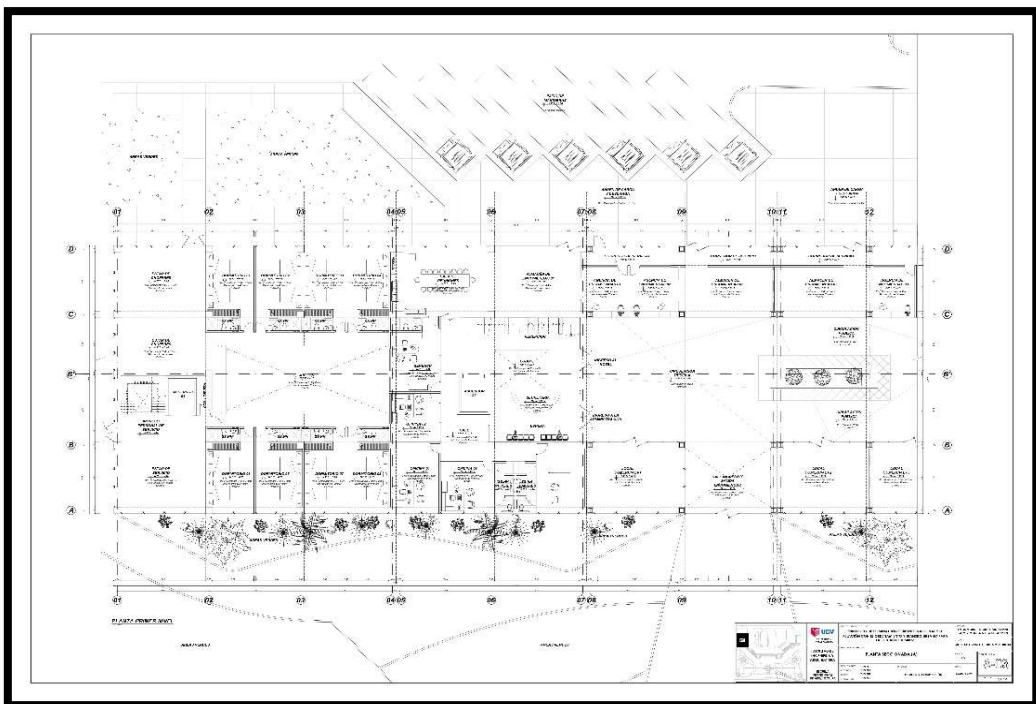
Plano Planta sector (A) Primer Nivel Fuente: Elaboración Propia.
